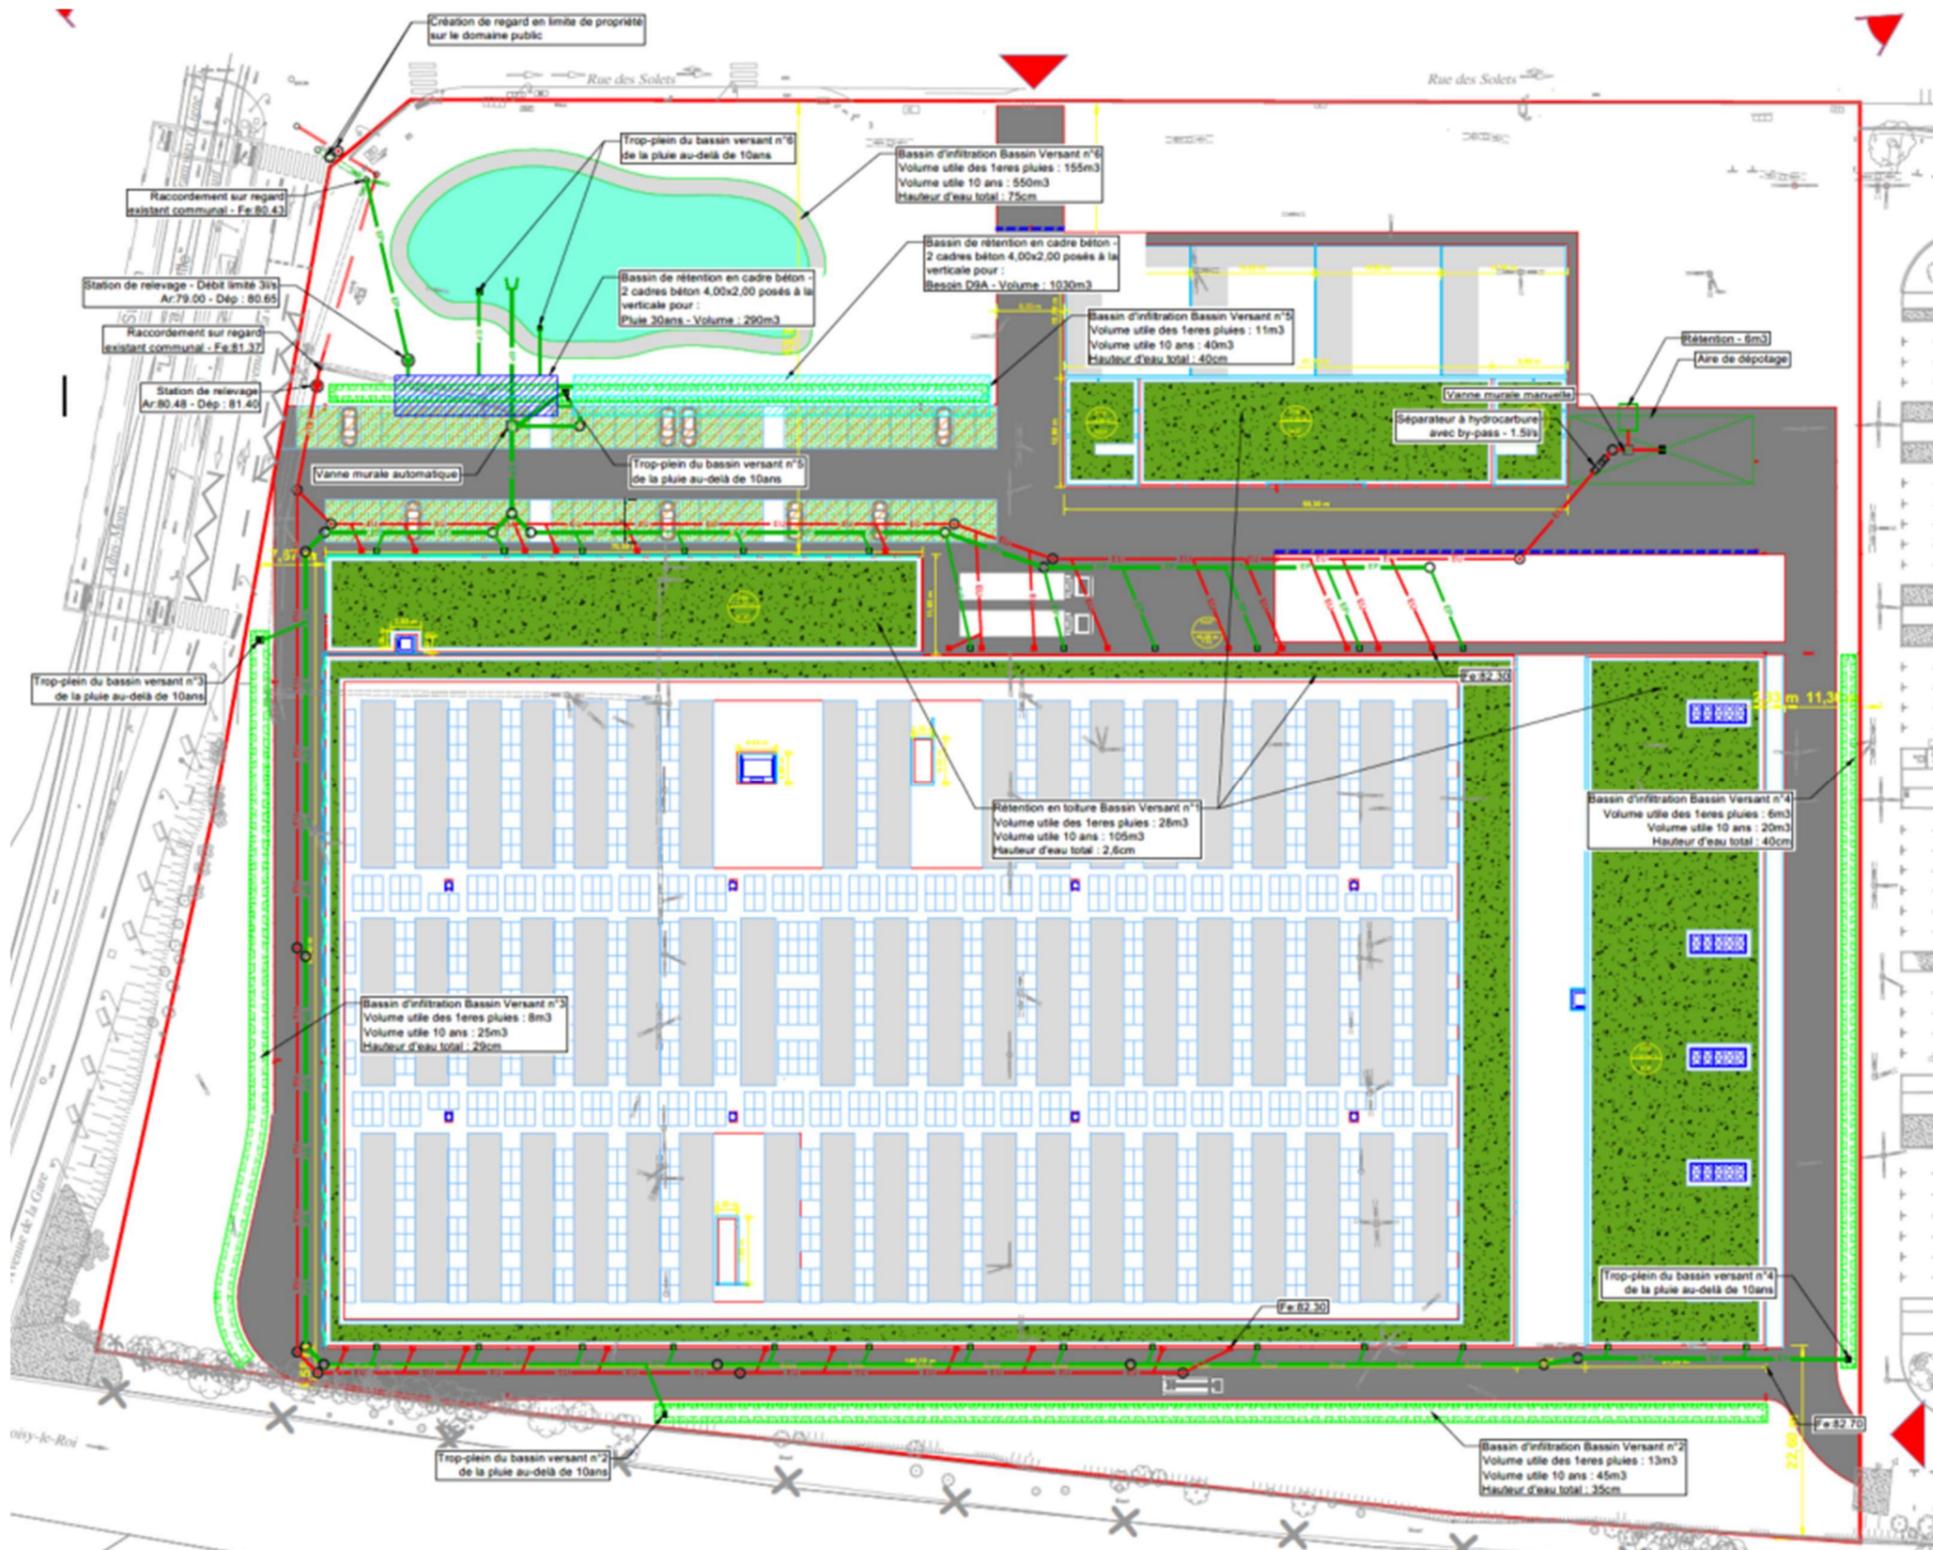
Plan de l'assainissement prévu sur le site du projet (source : CL Infra)
